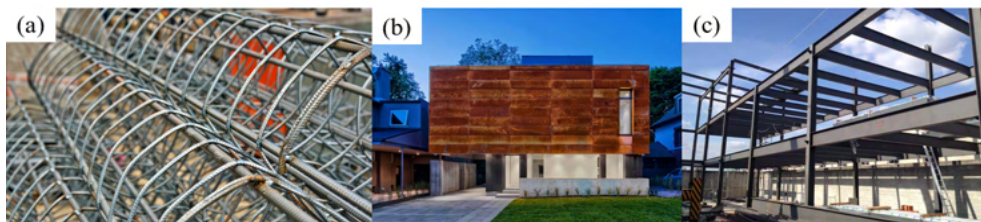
Aplicação do aço na construção civil: (a) armadura, (b) fachadas e (c) elementos estruturais.
